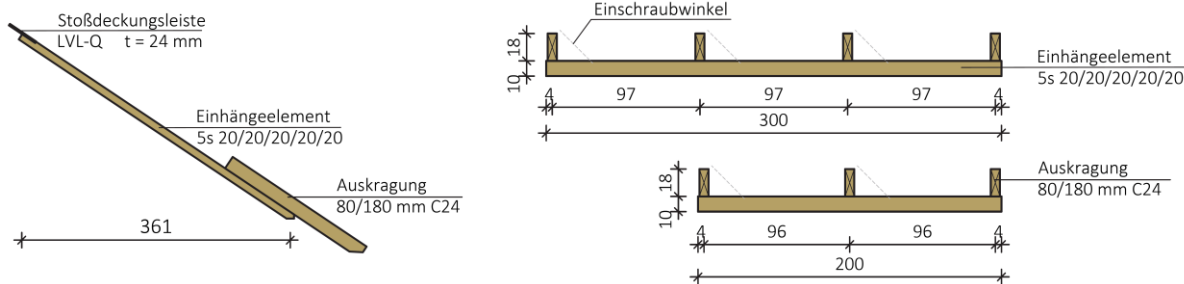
Einhängenelement mit vormontierter Auskragung – konstruktive Elemente
